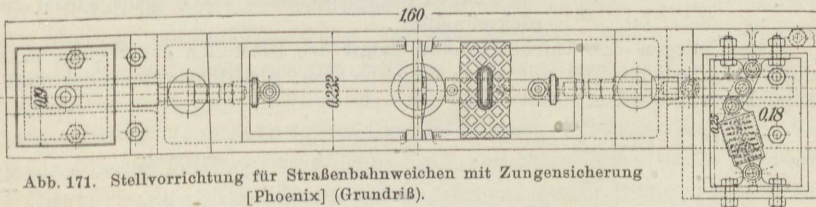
Stellvorrichtung für Straßenbahnweichen mit Zungensicherung [Phoenix] (Grundriß).
